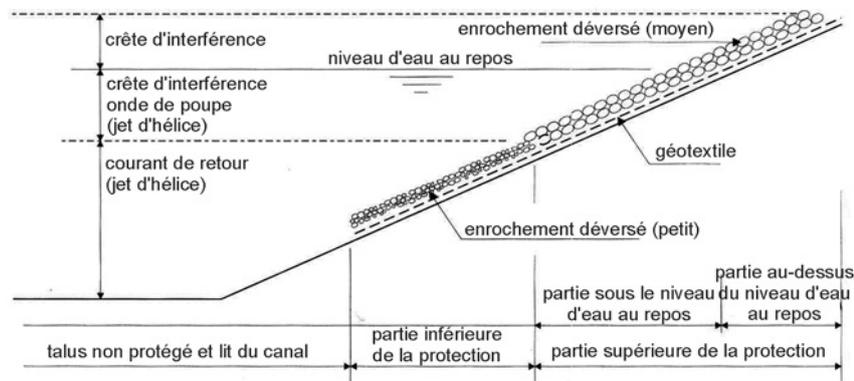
Solution classique retenue pour la protection du talus des canaux navigables – zonage de la protection
